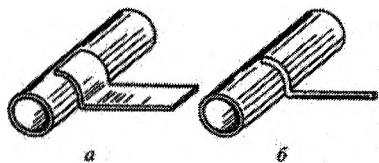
Приєднання до трубопроводу зварюванням заземлюючого провідника із прямокутним (а) і круглим (б) перерізом
